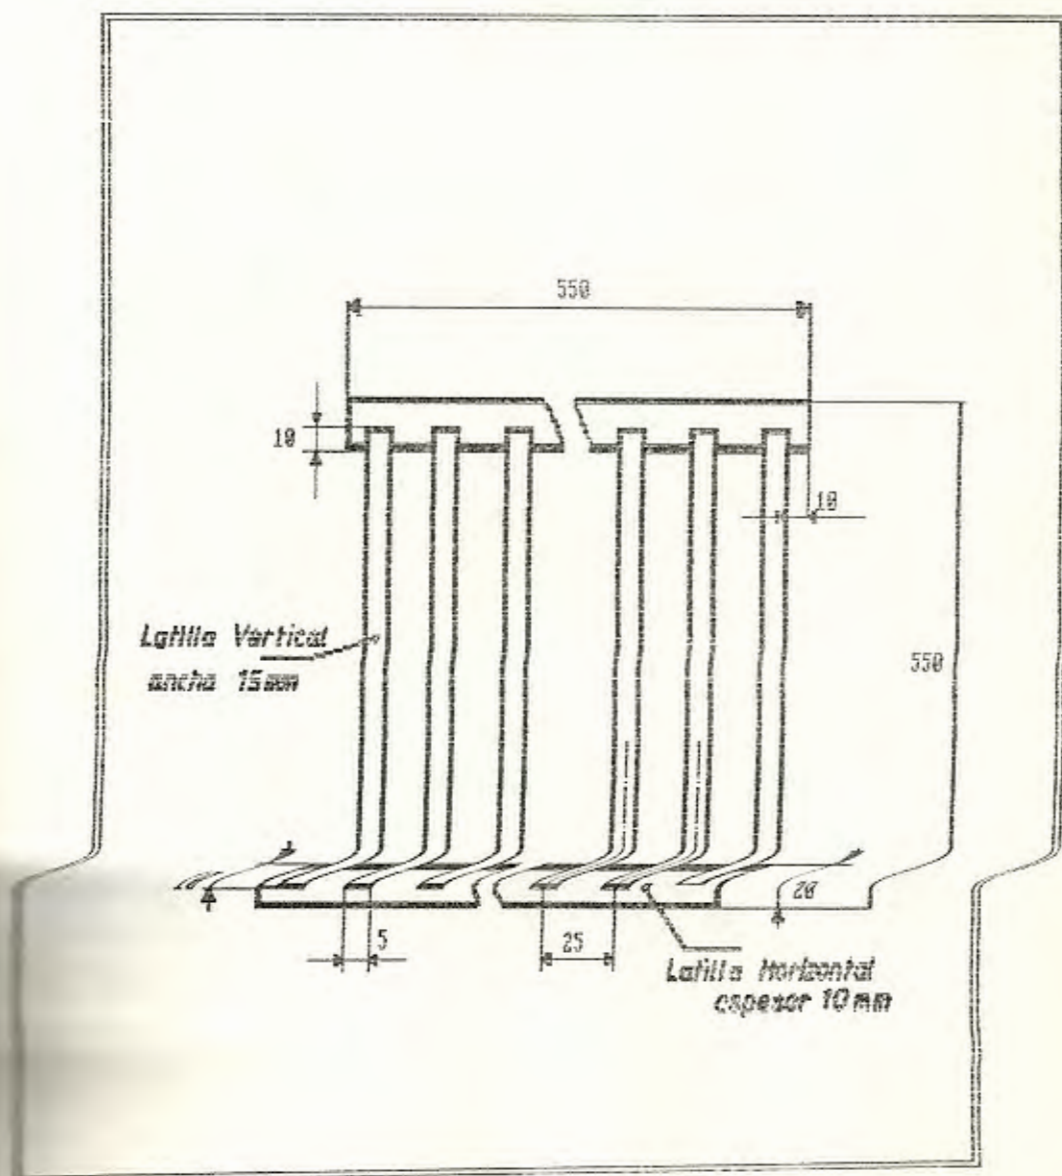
DIMENSIONES DE LA ESTRUCTURA DE CABA
